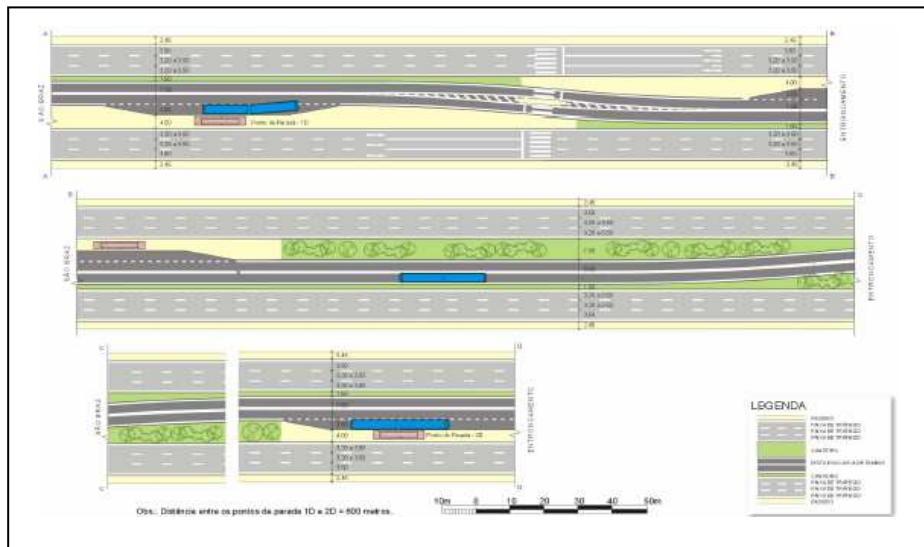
Plan propuesto por el PDTU/2001 para la Av. Almirante Barroso.
